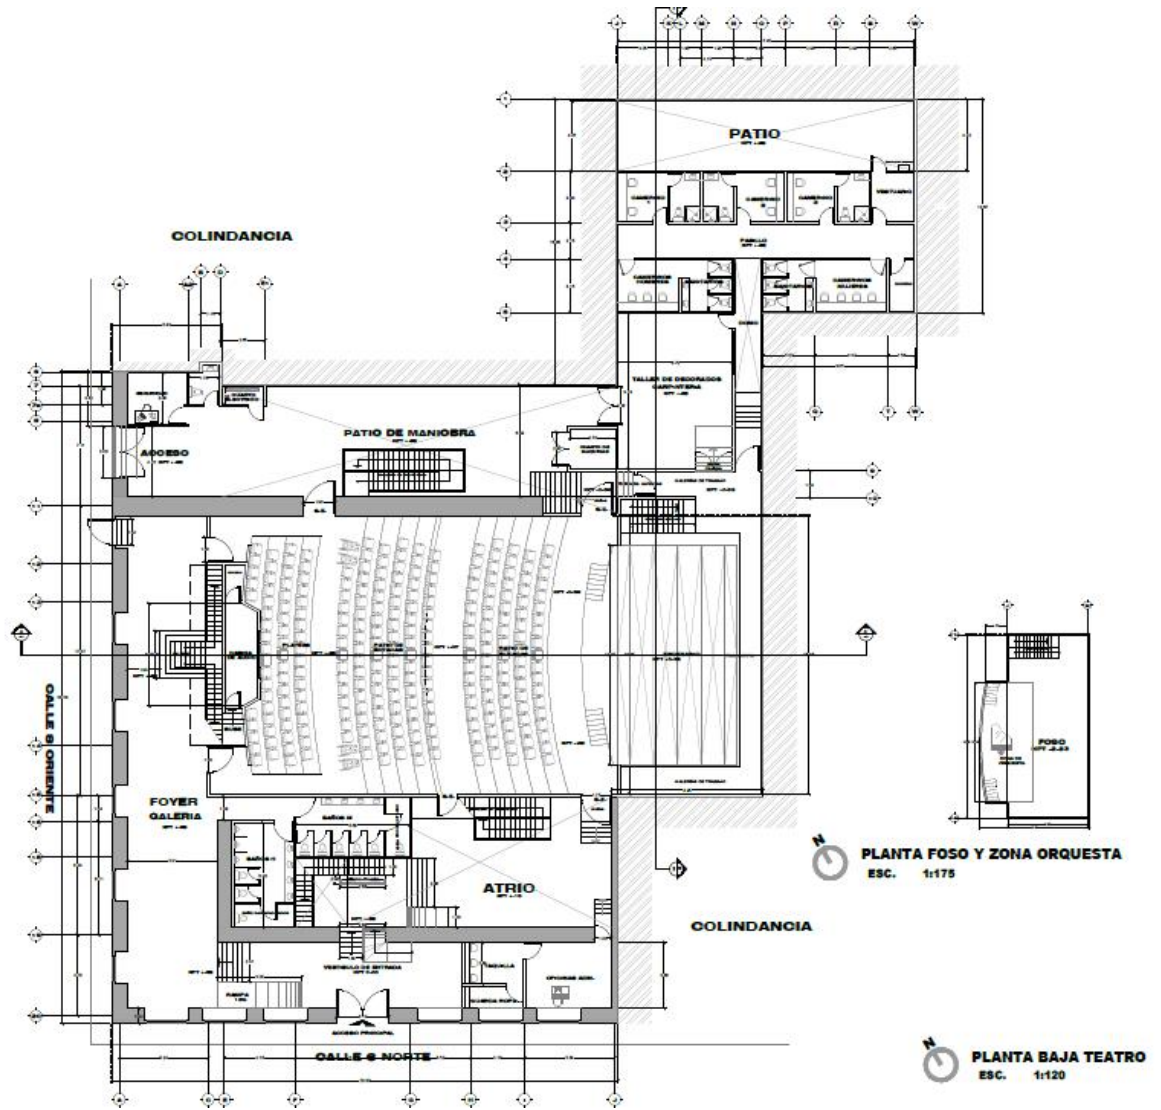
Planta arquitectónica baja (Fuente: Propia).
